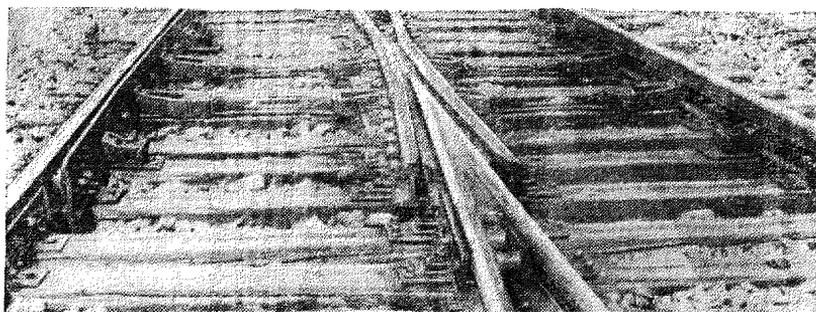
Крестовина с сердечником типа общей отливки с изнашиваемой частью усювиков, высокими контрольсами и распорками
